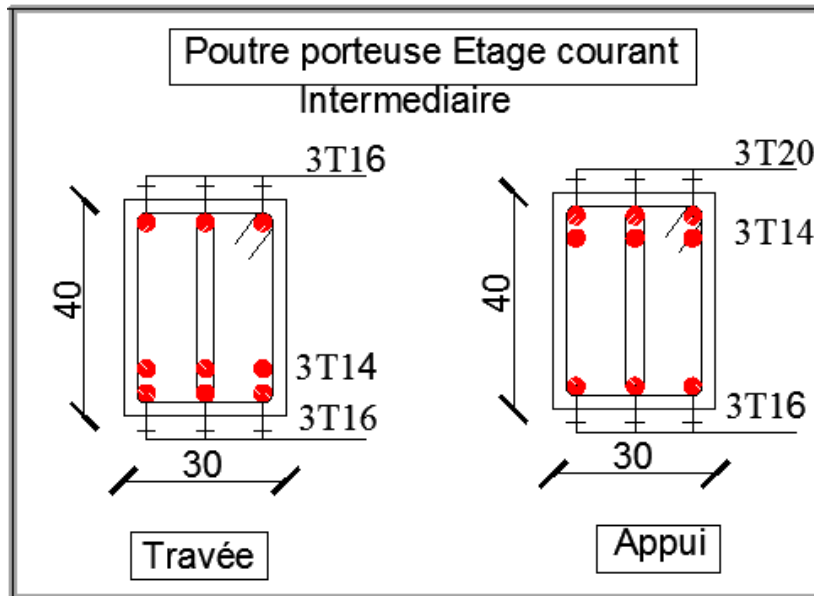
Ferrailage des poutres principales (30\*40) intermédiaires des étages.
